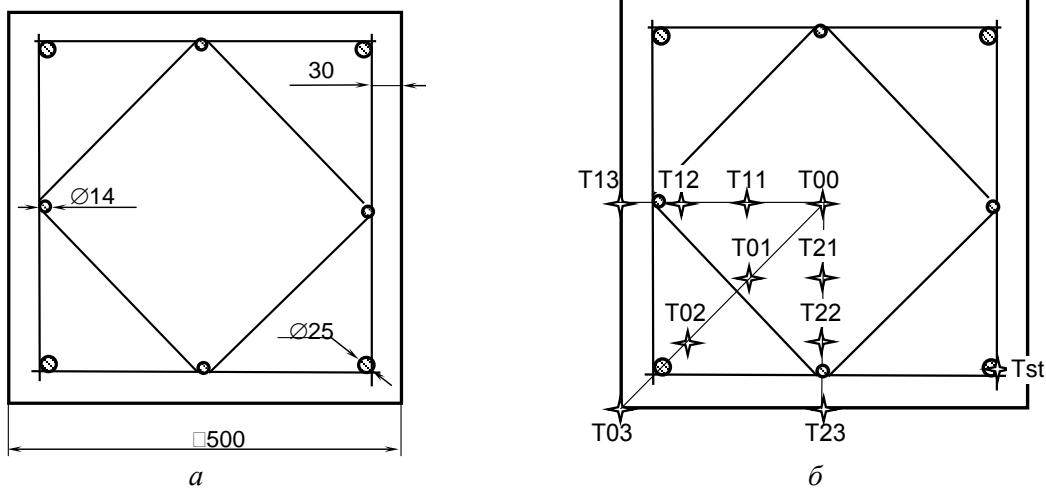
Схема армування (а) та схема розташування термонар (б) залізобетонної колони
